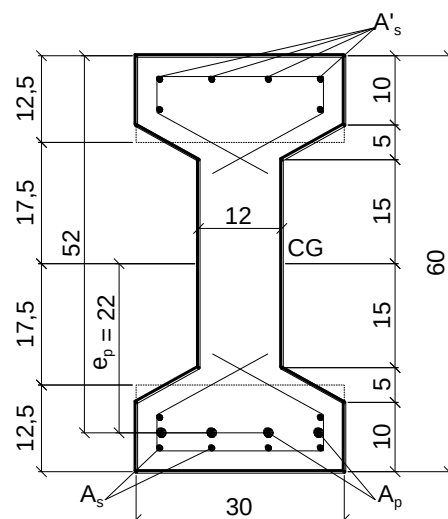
Dimensões (cm) da seção transversal da viga I.
